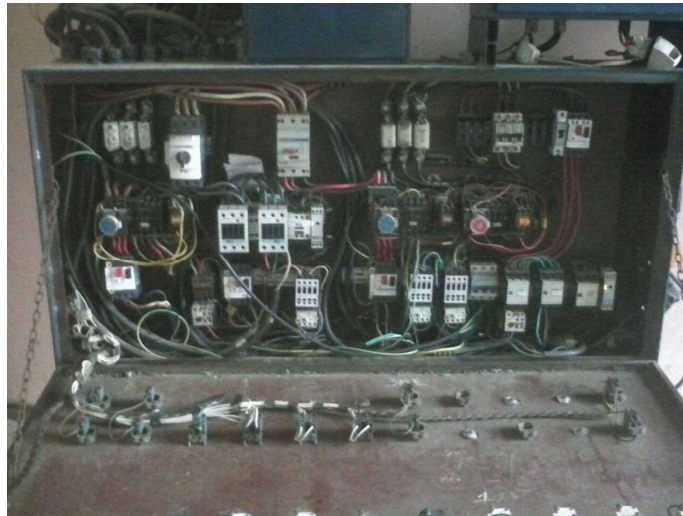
y 44: Foto del tablero eléctrico principal de la Citrícola Santa Carmen.
